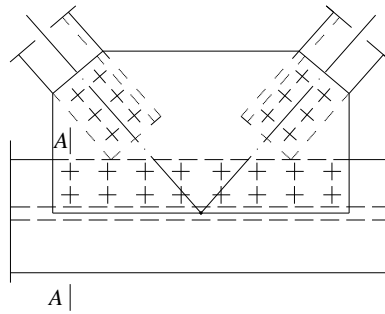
Расположение проверяемого на выносливость расчетного сечения А – А по основному металлу в сечении брутто по первому ряду высокопрочных болтов в прикреплении фански к нестыкуемым в данном узле поясам сплошных балок и элементам решетчатых форм
